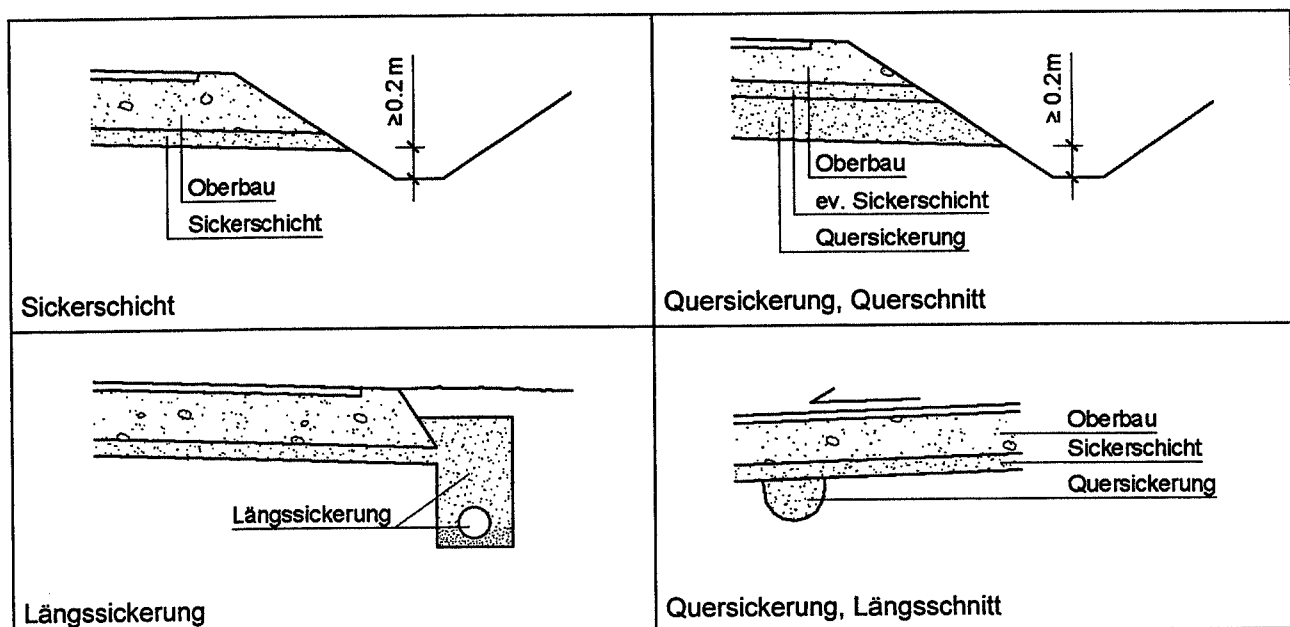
Ausführung von Sickerschichten, Quer- und Längssickerungen
